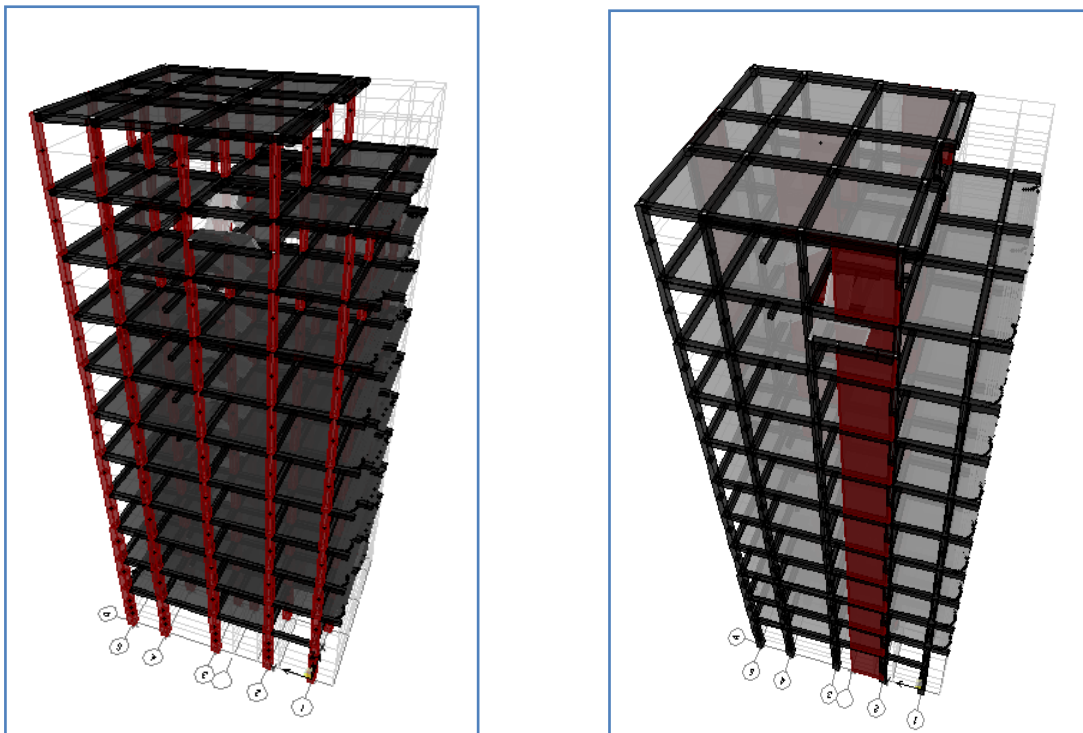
Model tridimensionnel de la structure auto stable et mixte respectivement
